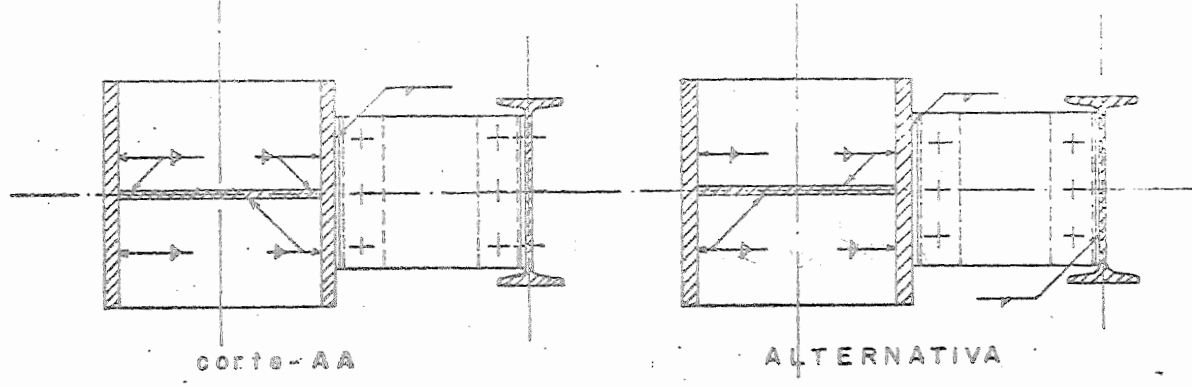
LIGAÇÃO DE UMA VIGA DE ROLAMENTO SOBRE COLUNETA À COLUNA DE SEÇÃO CONSTANTE.
